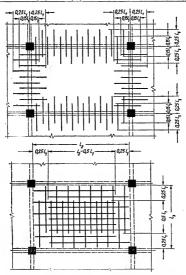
61. Схема армирования плиты, опертой по контуру. План верхней и нижней арматуры.
